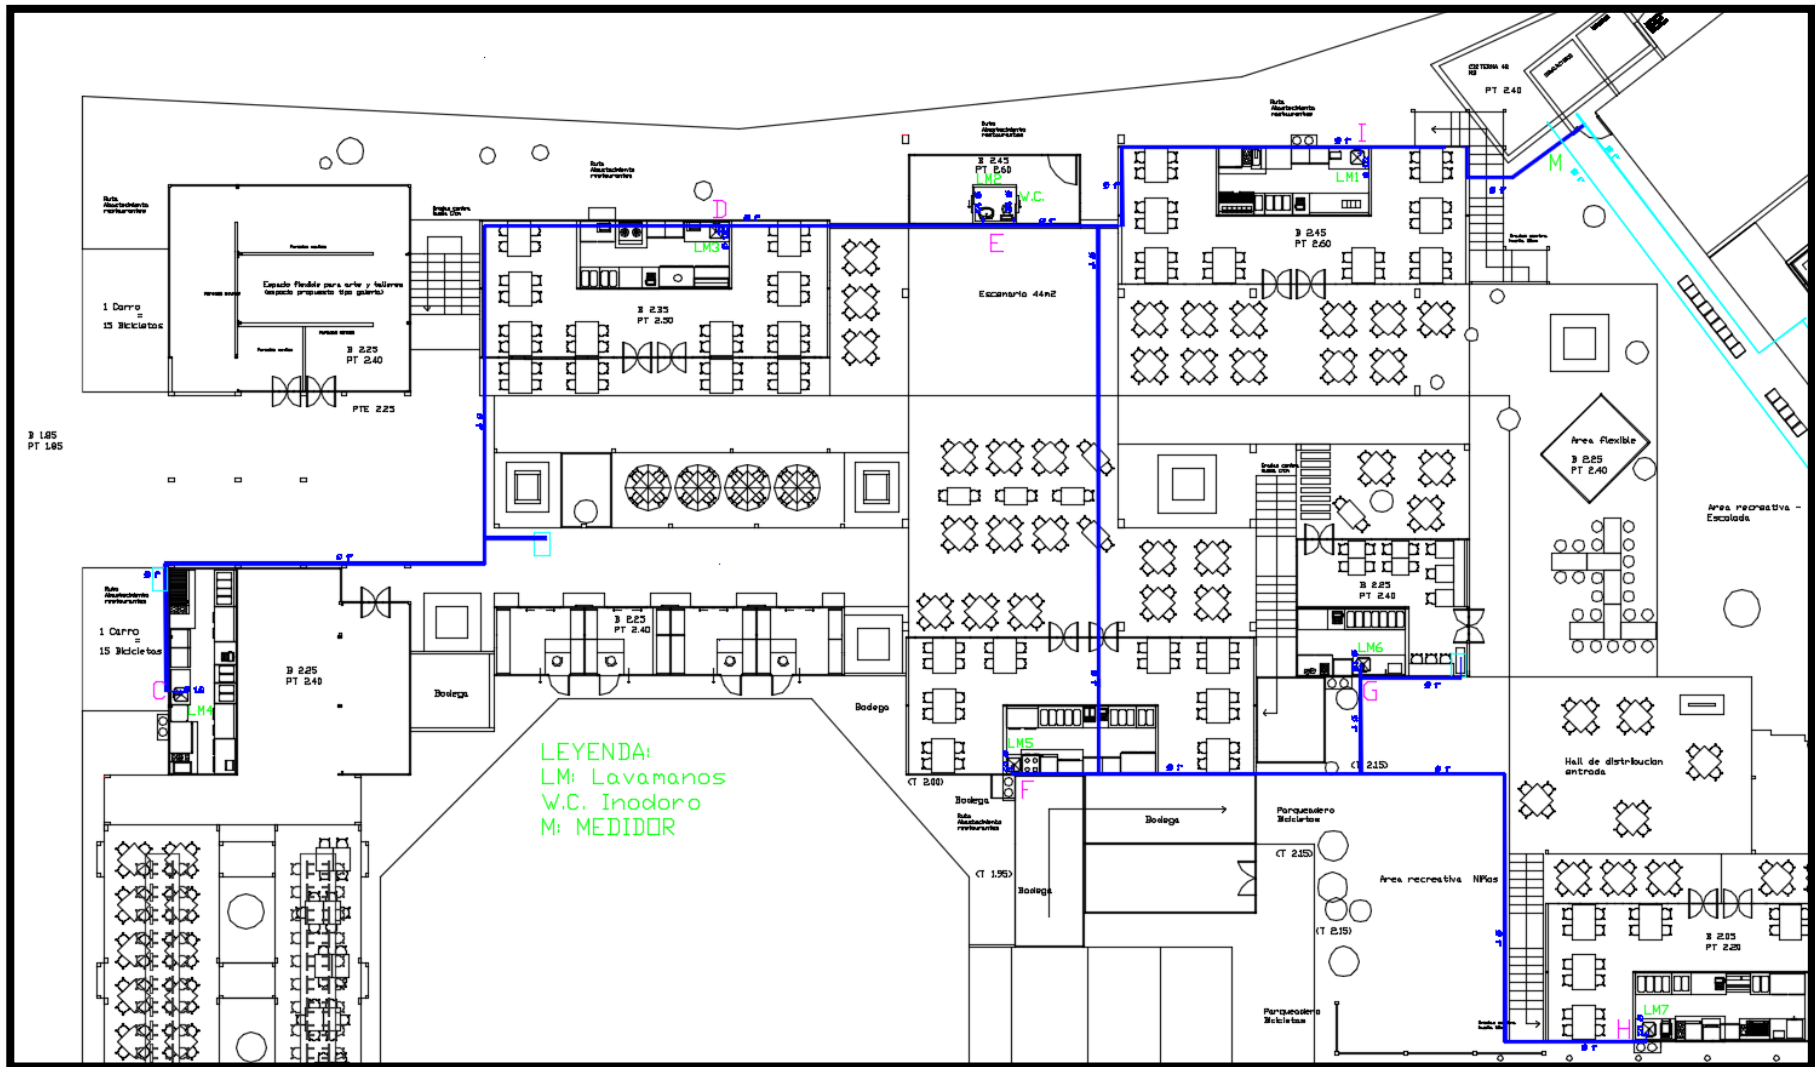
Vista en planta de la red de agua potable del 1er piso de La Galería
